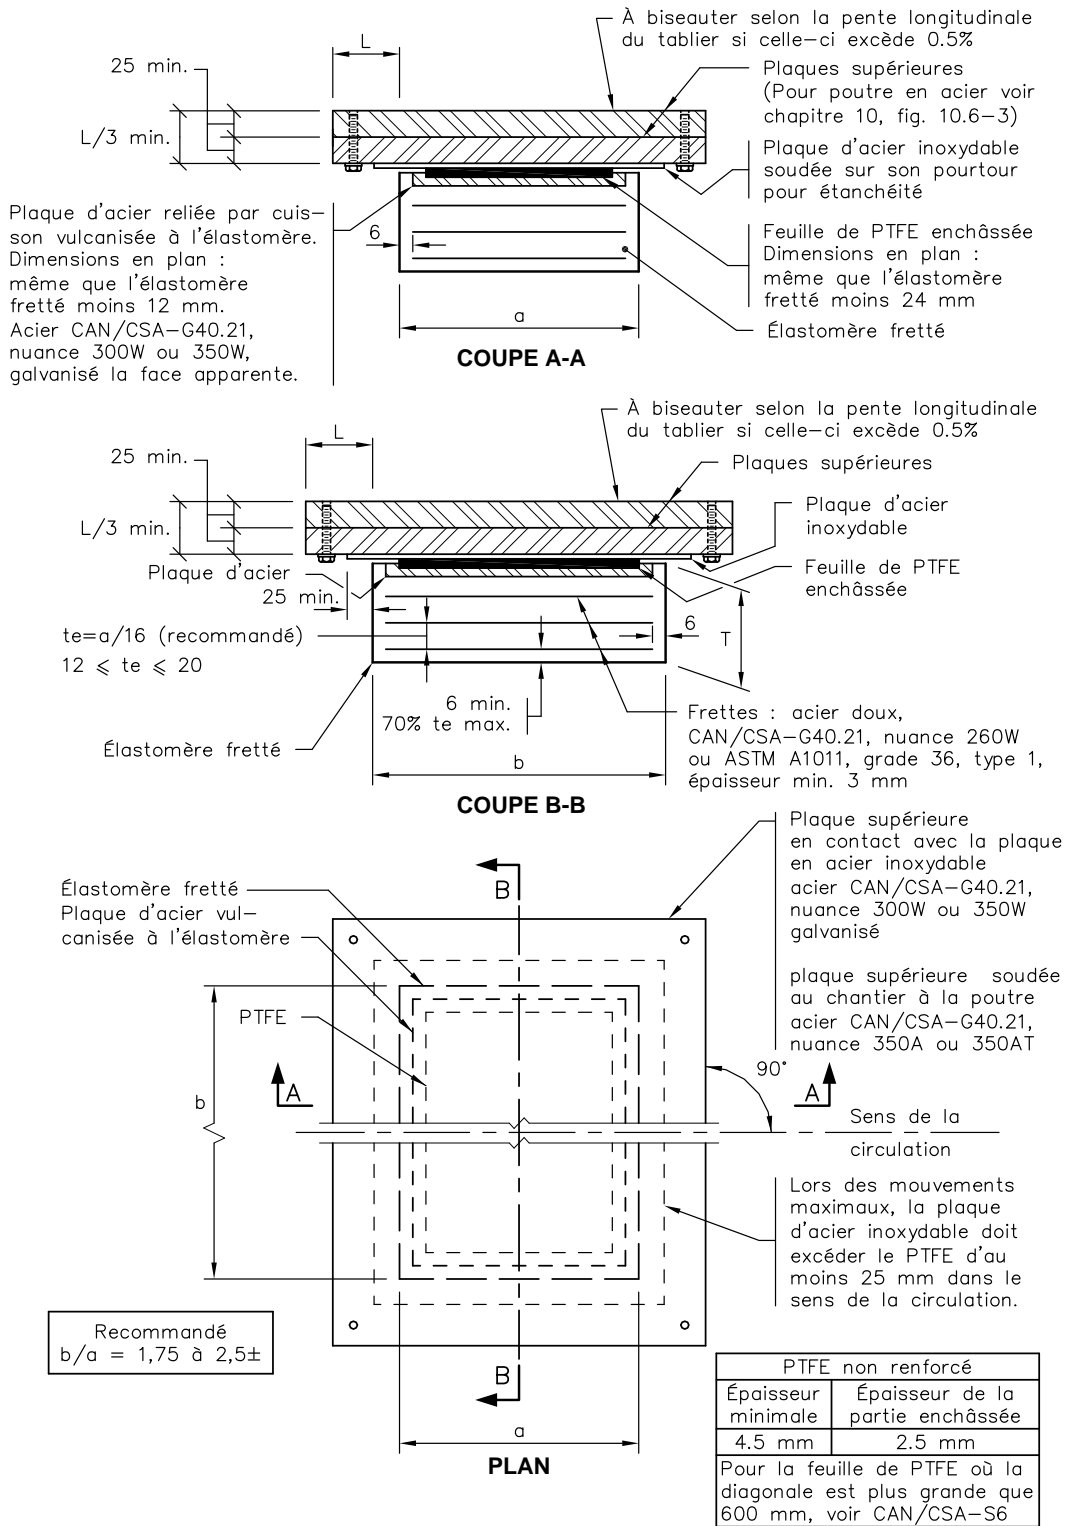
Appareil d'appui en élastomère fretté avec éléments glissants remplaçables
